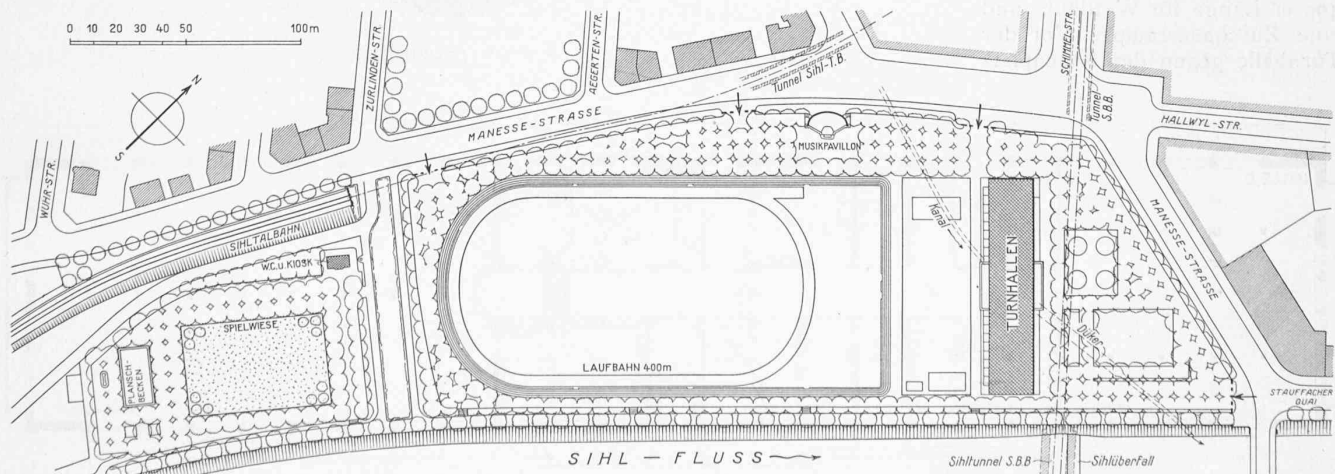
Lageplan der neuen Sport- und Grünanlagen auf dem ehemaligen Sihlhölzliareal. — Masstab 1 : 3000.
